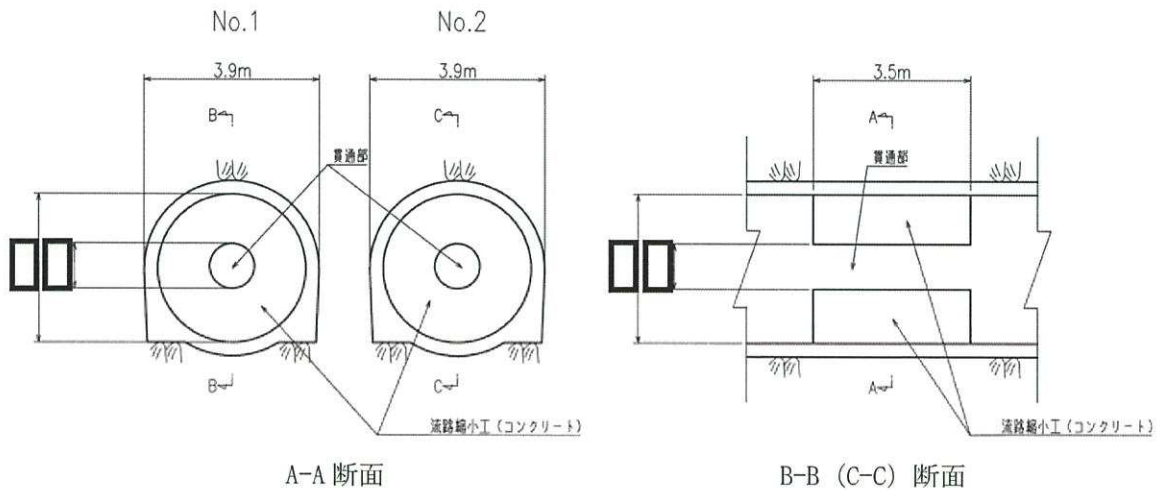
取放水路流路縮小工（第1号機取水路）(No. 1), (No. 2)の断面図
